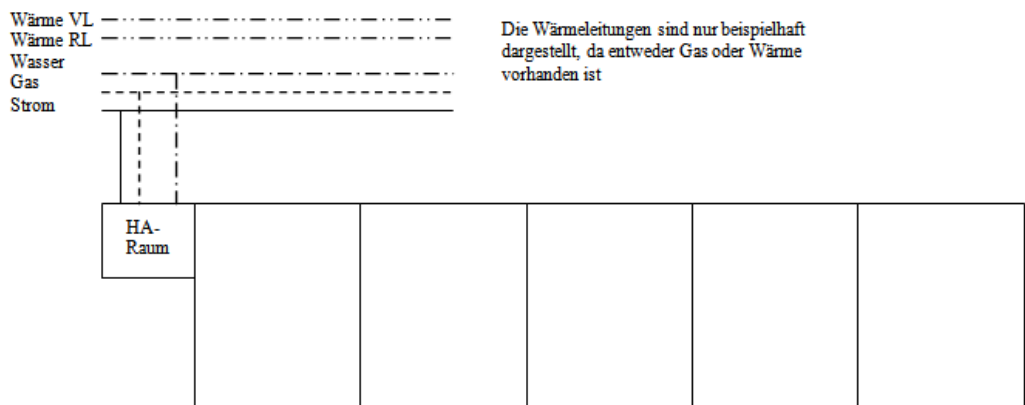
Installationsaufbau Mehrspartenhauseinführung
